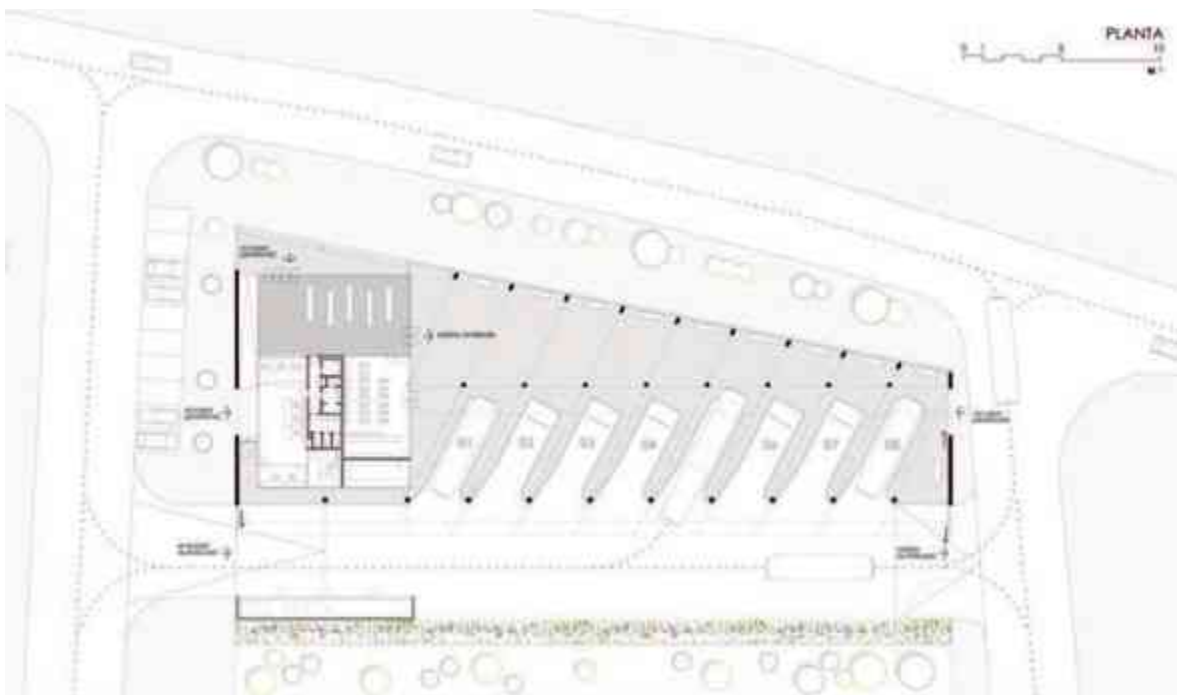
Planta arquitectónica de la central de autobuses Baeza. Archdaily.
